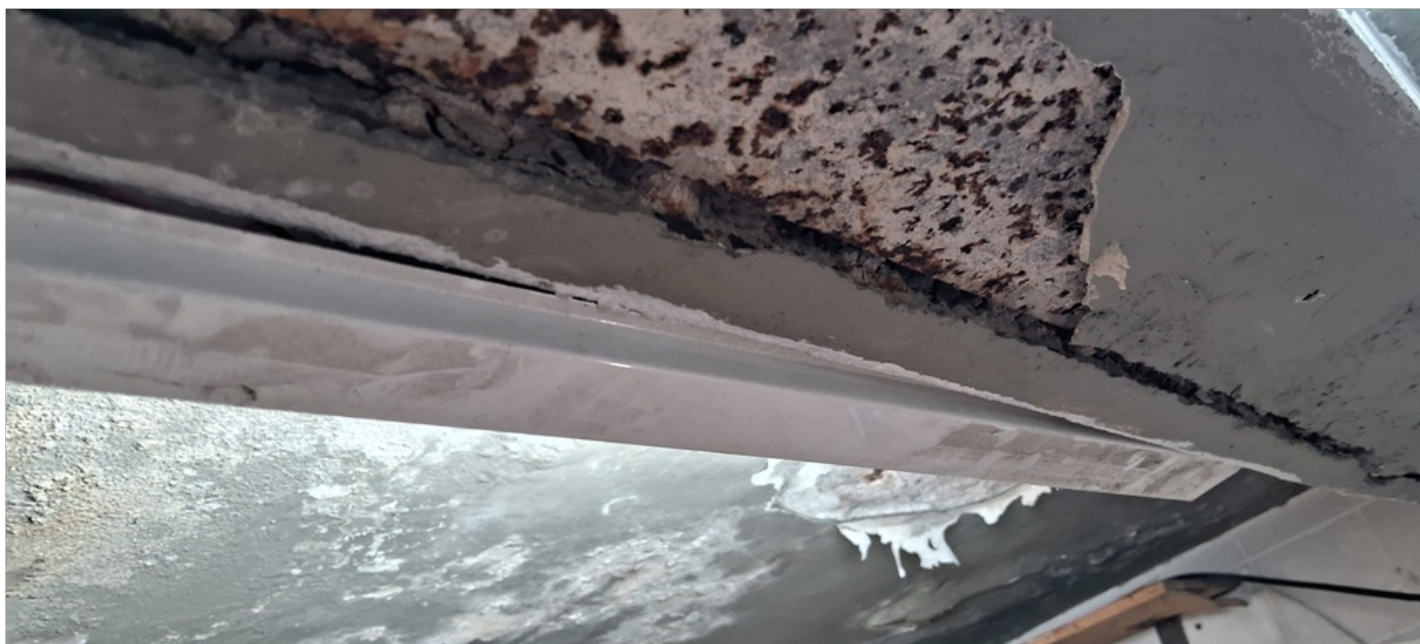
Rachadura na face inferior de viga de concreto armado.
